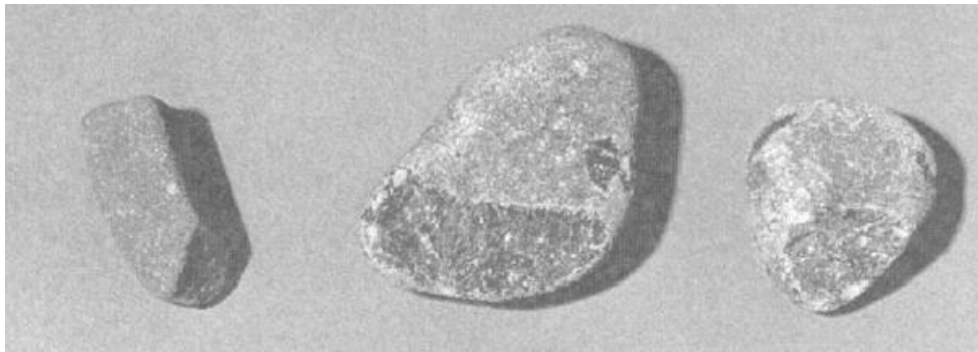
5. Partícula fracturada, flanqueada por dos partículas no fracturadas (solo desportilladas)
